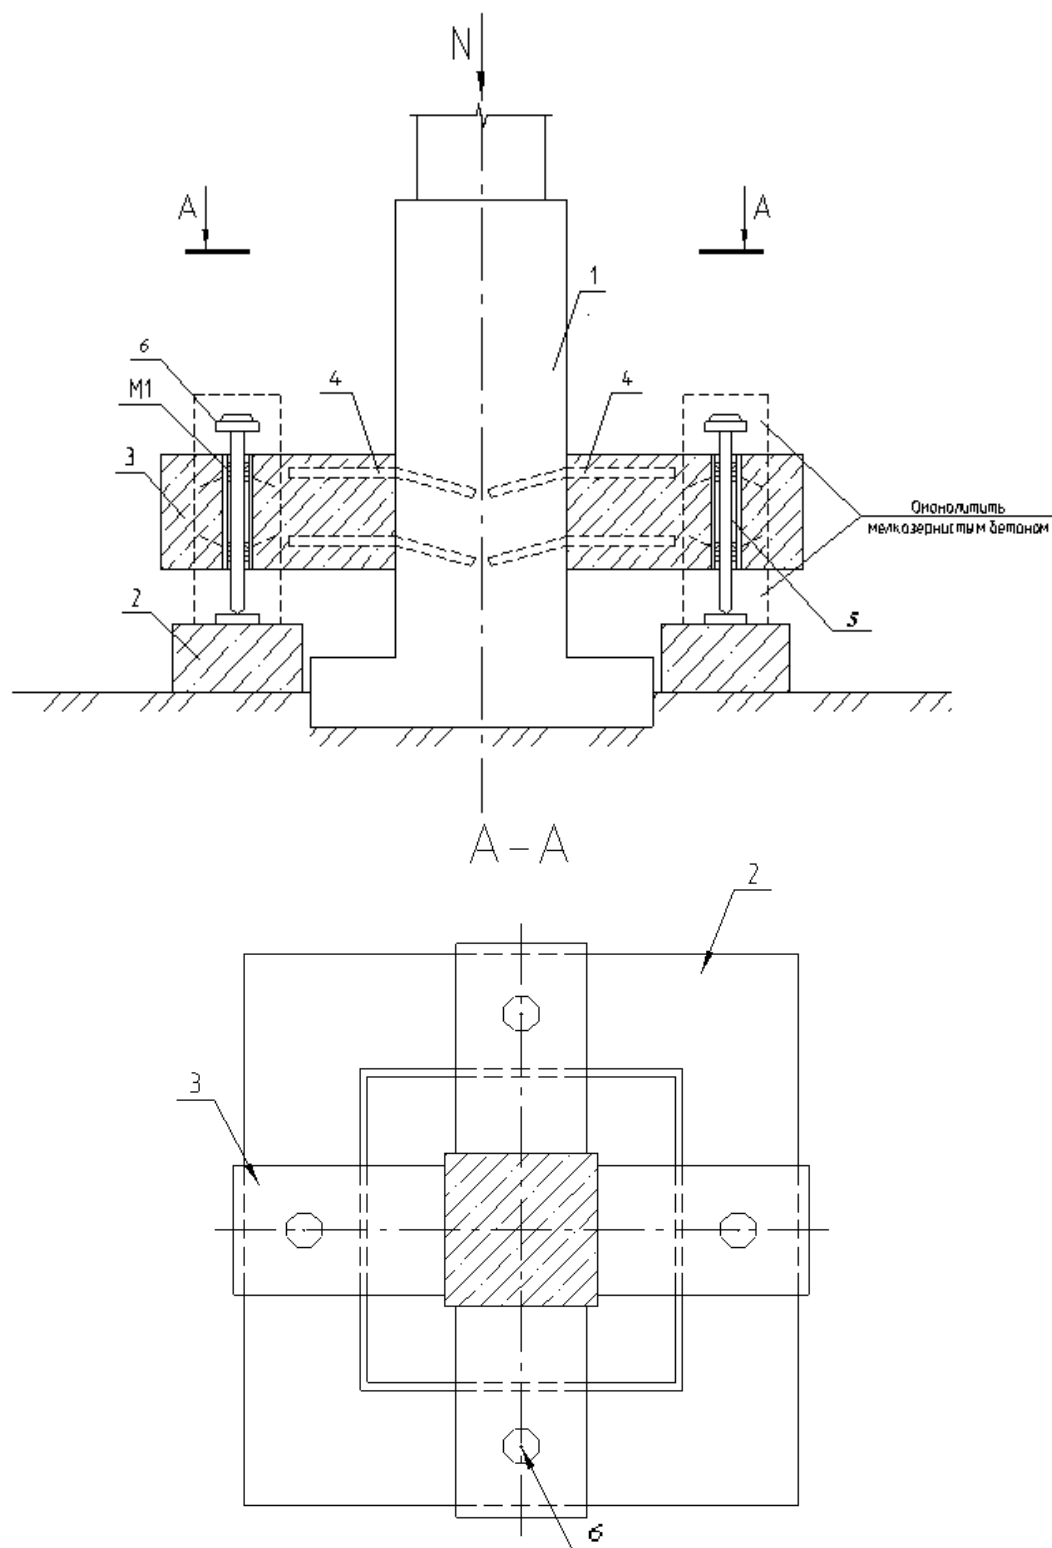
Устройство для усиления фундамента с предварительным обжатием грунта основания:
